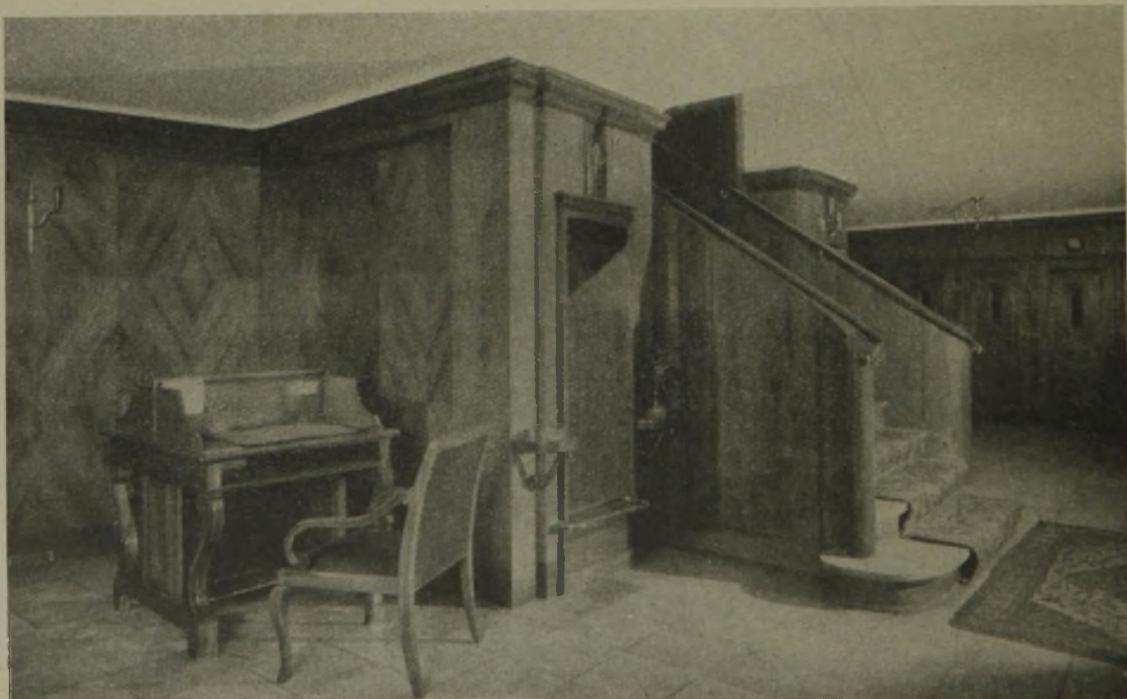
Untergeschoß. Garderobenraum mit Treppe zum Erdgeschoß. Kirschbaumholz poliert.
